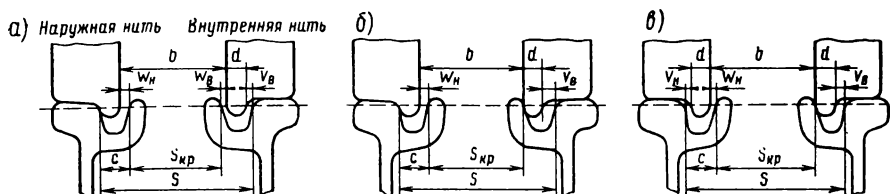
Варианты взаимодействия колесной пары с рабочими канатами рельсовой колеи
